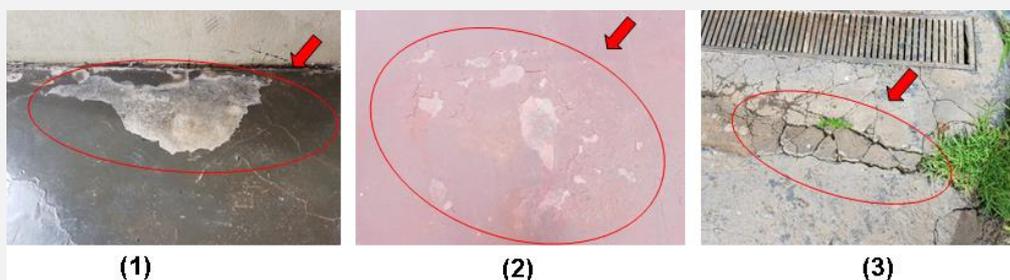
Fissuras no piso. Fonte: Autores.
